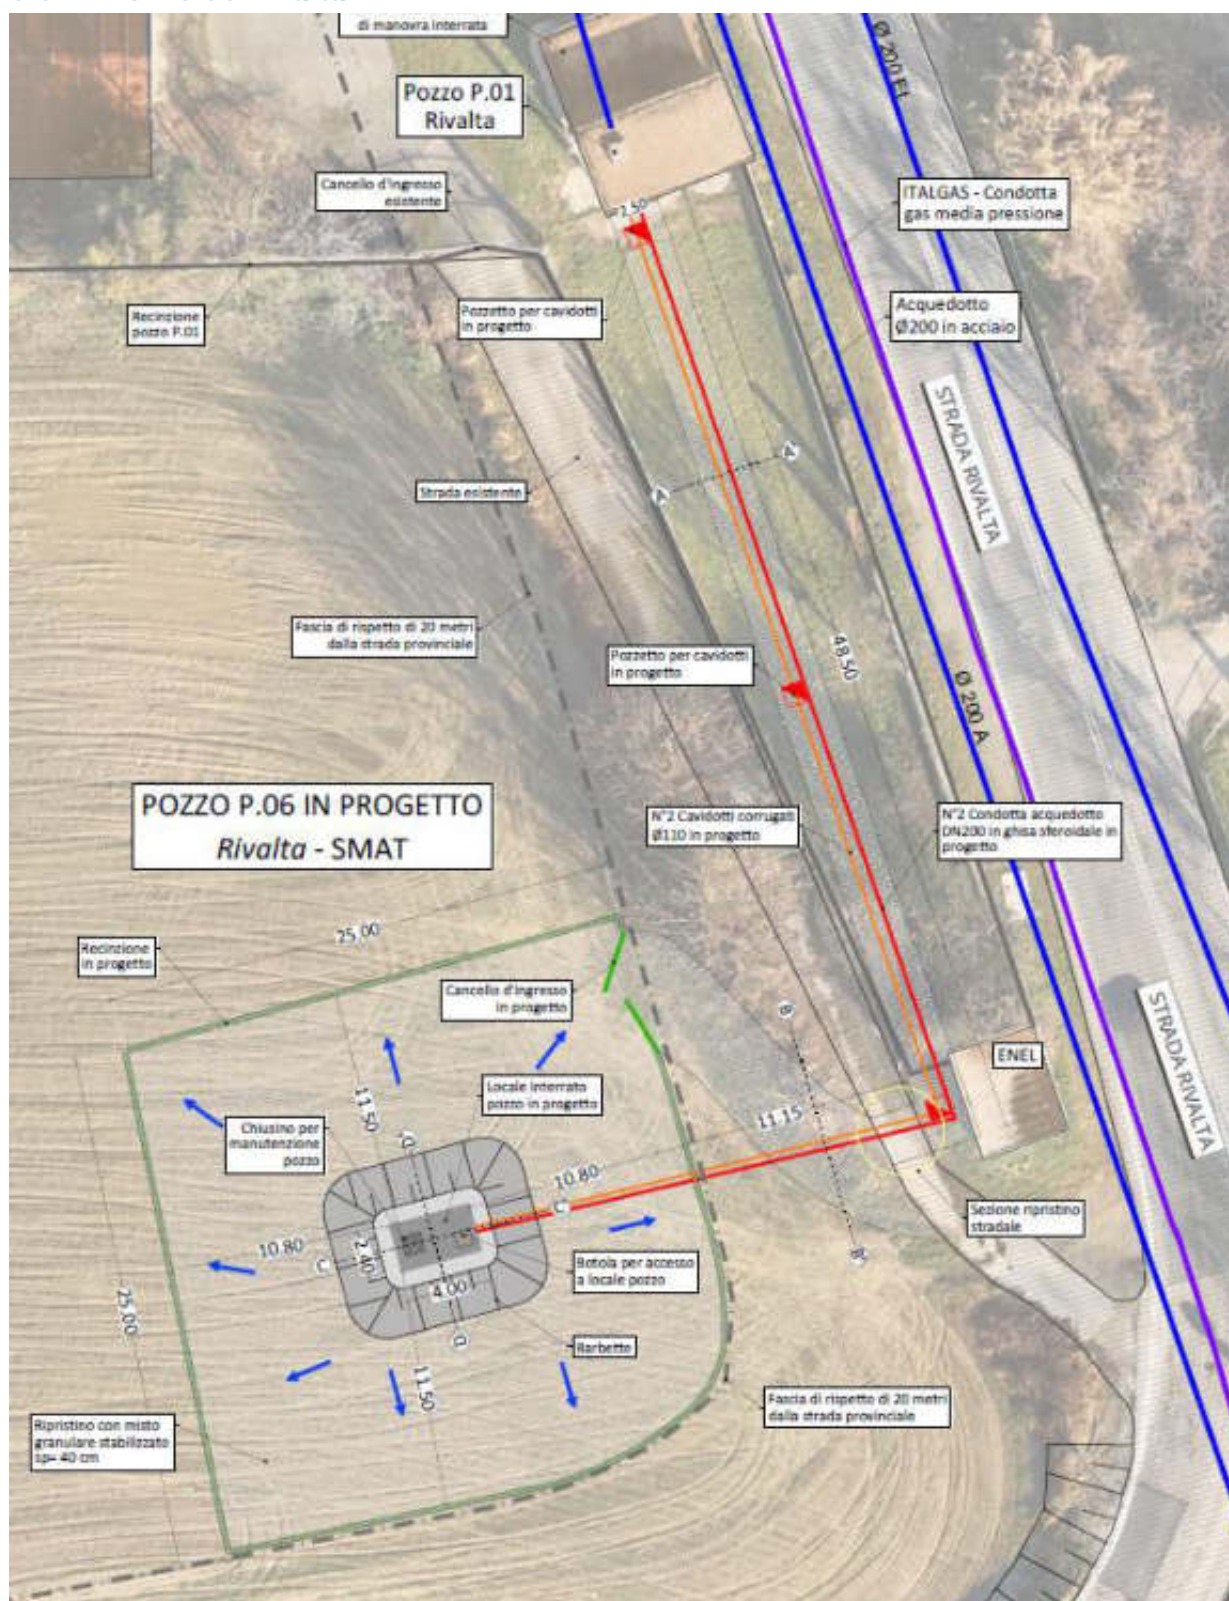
Estratto planimetria di progetto pozzo *Rivalta
